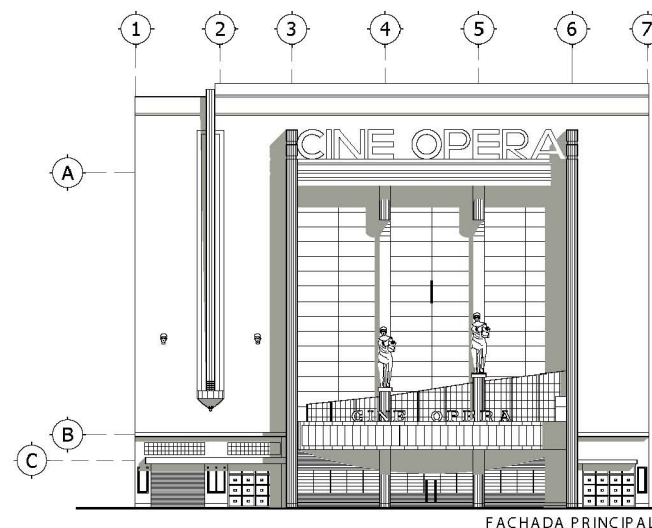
Fachada E. Dibujo del levantamiento actual de la fachada
